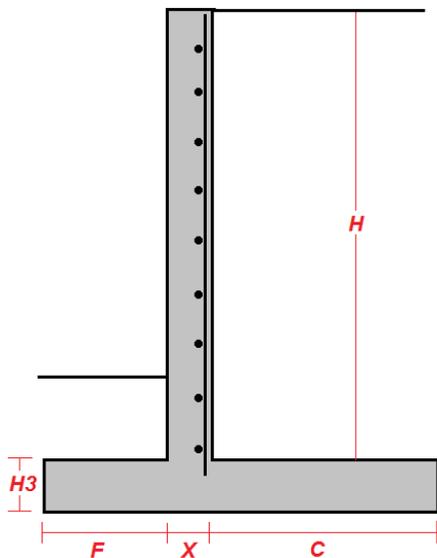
Colocación del acero del vástago para un muro tipo voladizo
